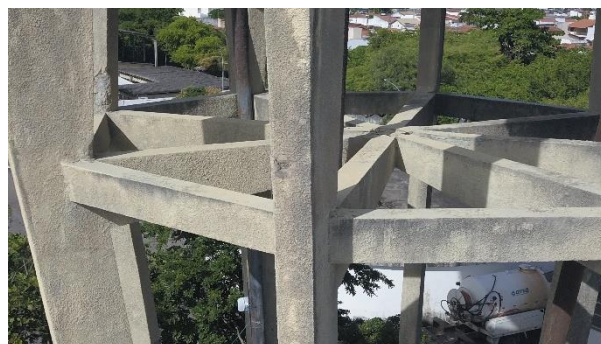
Vista geral das vigas intermediárias internas de travamento.
